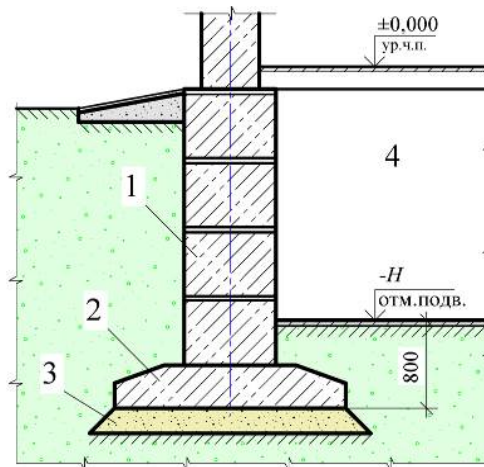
Схема устройства подвала с обеспечением заделки фундамента в грунте: 1 - существующий фундамент; 2 – фундаментная подушка; 3 – щебеночная подготовка; 4 – подвал
